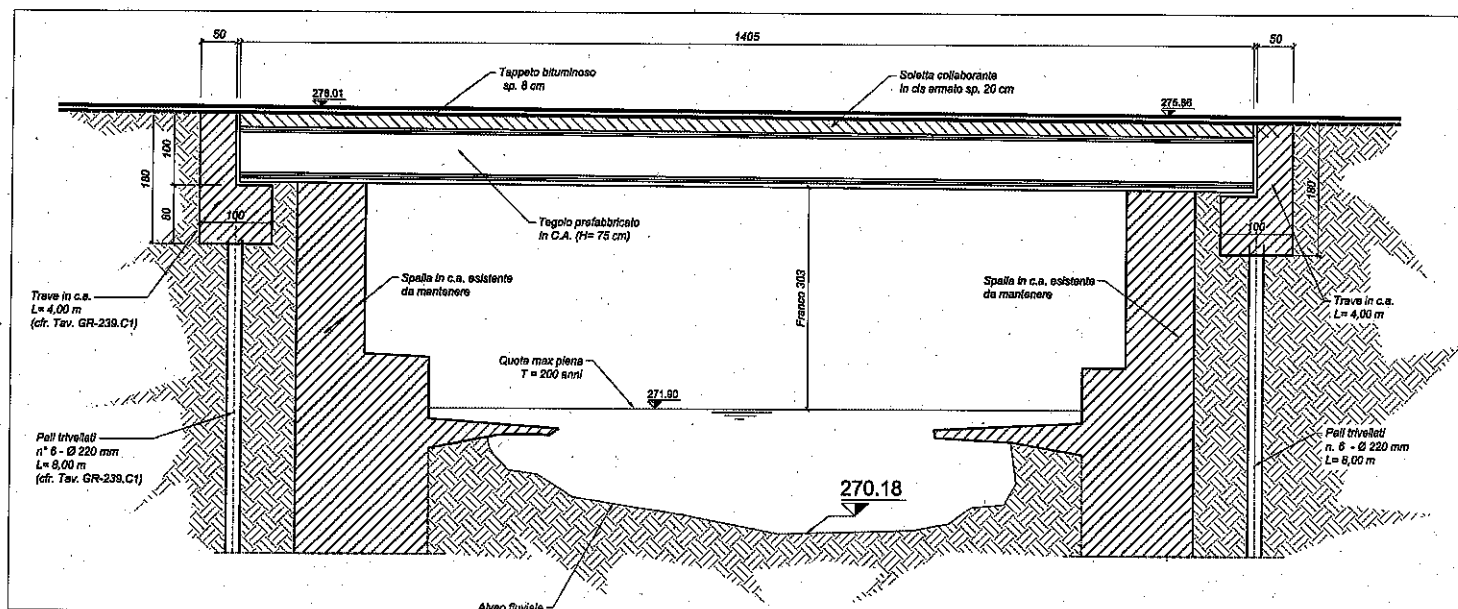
Sezione di progetto Ponte sul Rio Croso (cfr. Relazione Generale, pag. 6)
